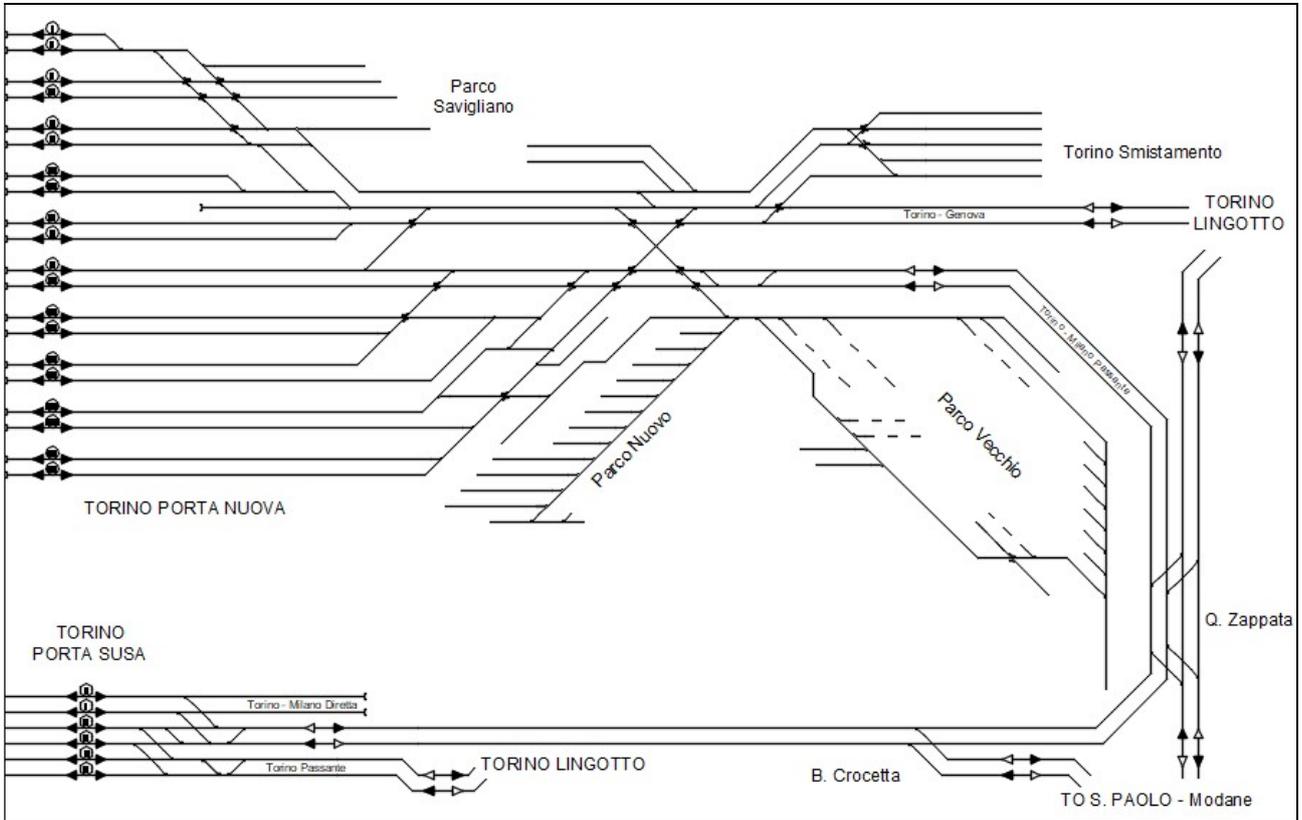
Stato attuale Stazione di Torino Porta Nuova – ingresso linee TO-Mi e TO-GE – Planimetria
